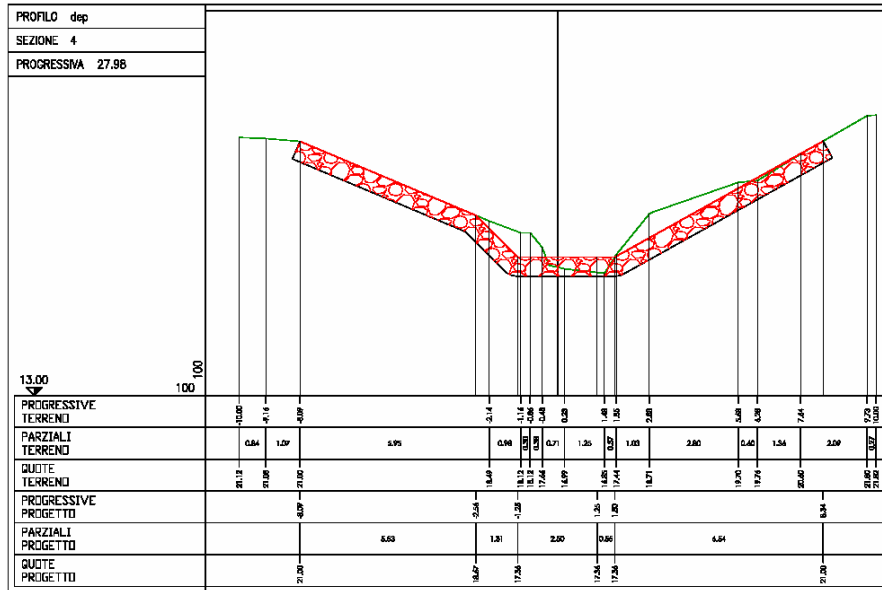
Sezione di rilievo e di progetto della scogliera dell'intervento a.
